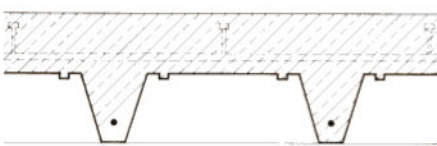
Hoesch Additiv Decke (Sonderfall Flachdecke)
